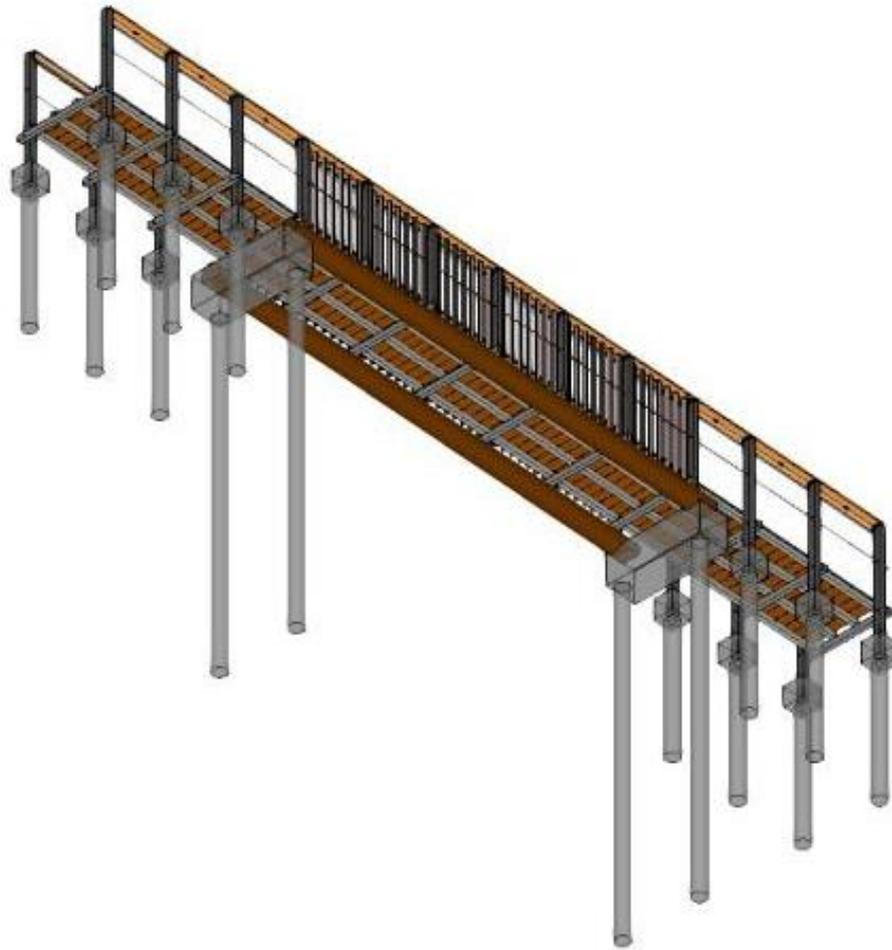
Vista de baixo da estrutura da ponte com destaque para a viga cilíndrica de eucalipto tratado fixado em vigas biapoiadas de concreto fixadas em brocas de concreto.
